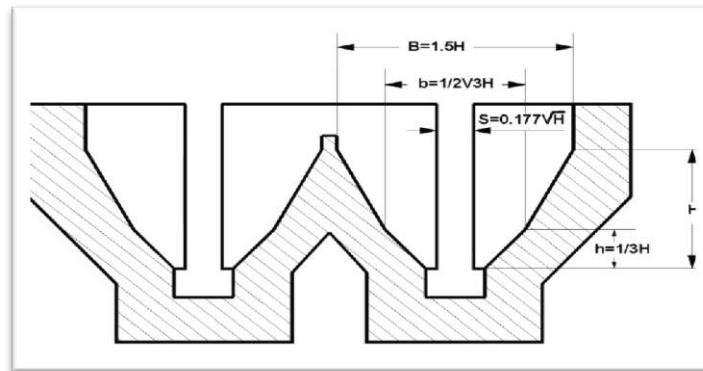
Section hexagonale d'un dessableur à section parabolique
